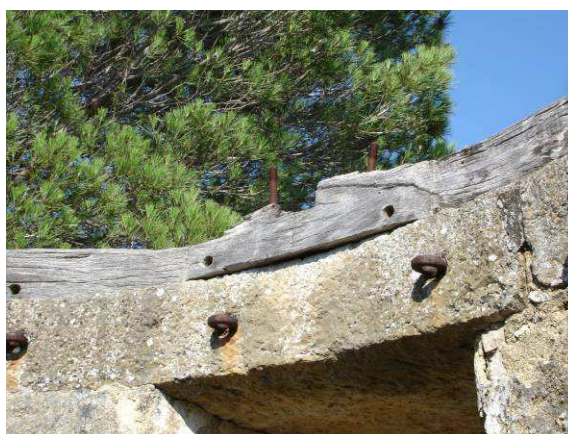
Exemplo de argamassa utilizada nas juntas - moinho MV034.
